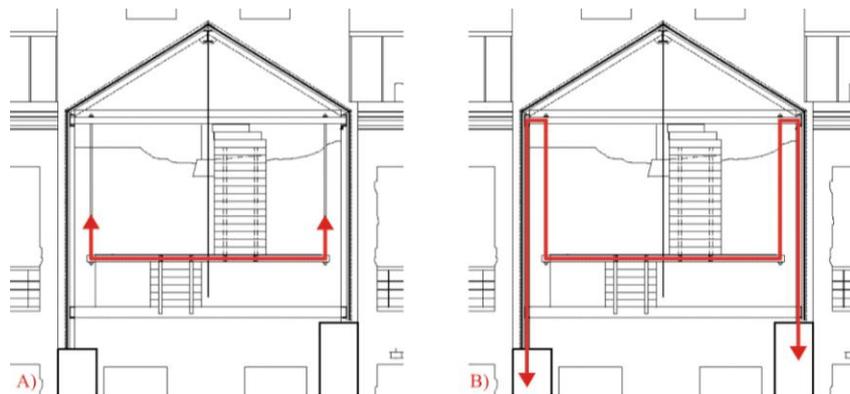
Corte longitudinal parcial: Caminho das cargas no patamar atirantado.
